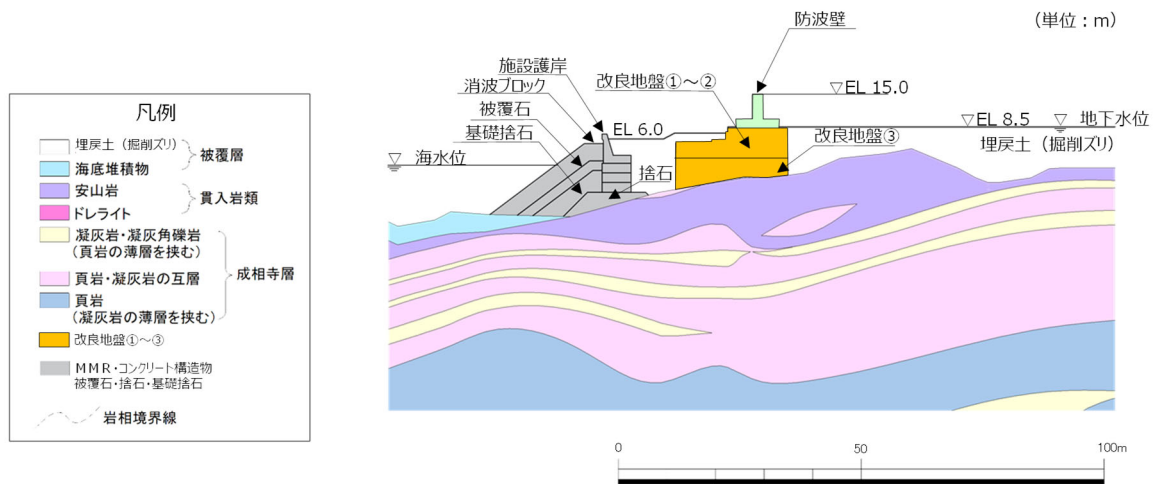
防波壁（逆 T 擁壁）の横断面図（②-②断面）
